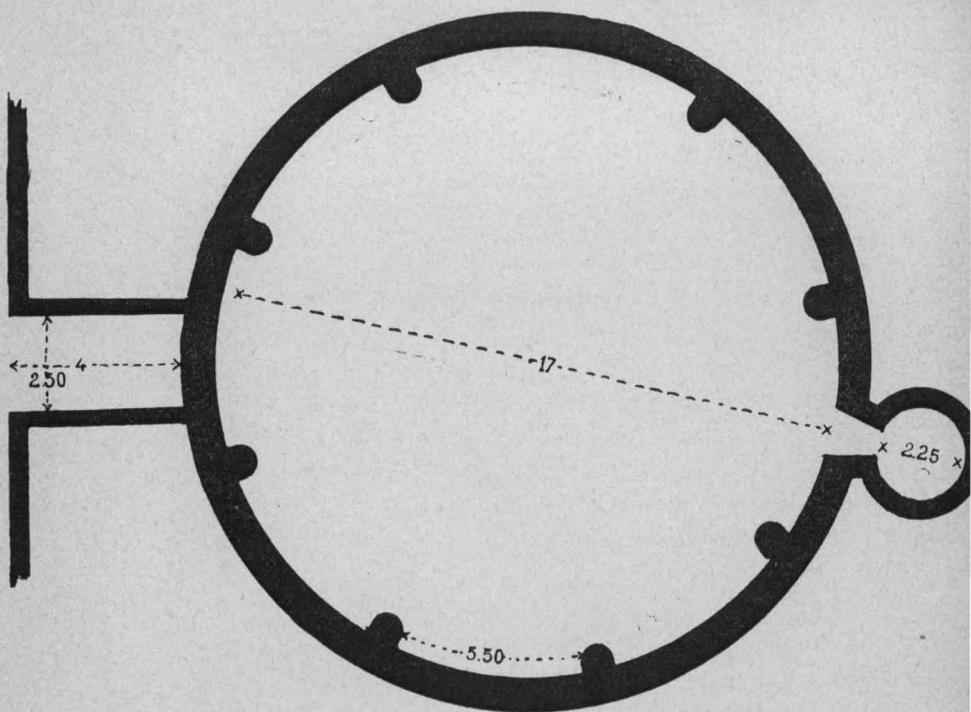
FESQUIET-EL-ARAD. Plan.
